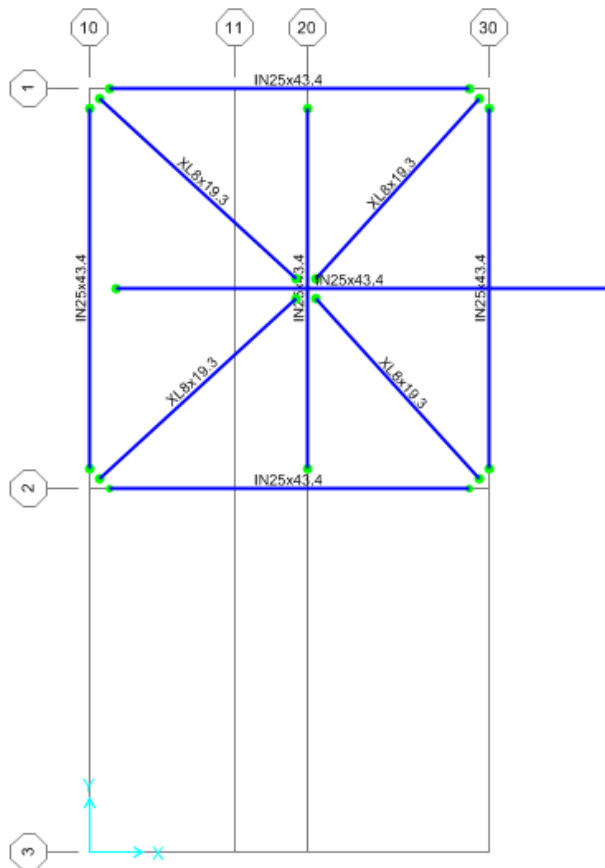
Planta Elevación 5.7 m sobre el nivel de terreno.
